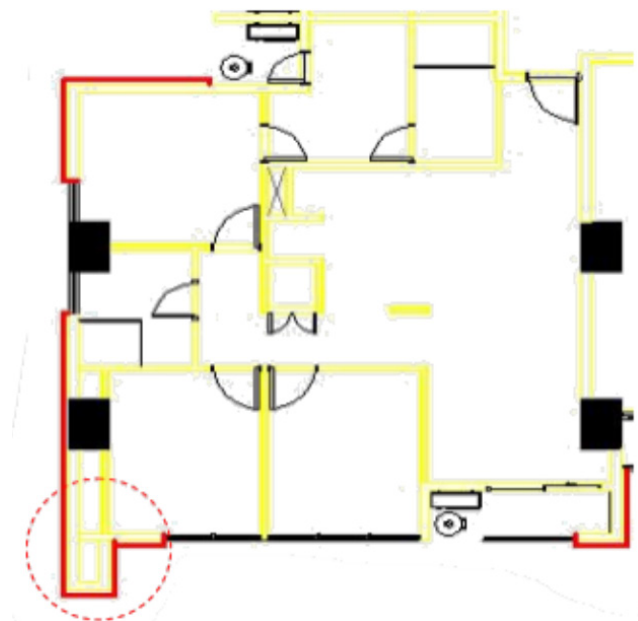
Vista en planta de área de aplicación de paneles para fachada. (Elaboración propia)
